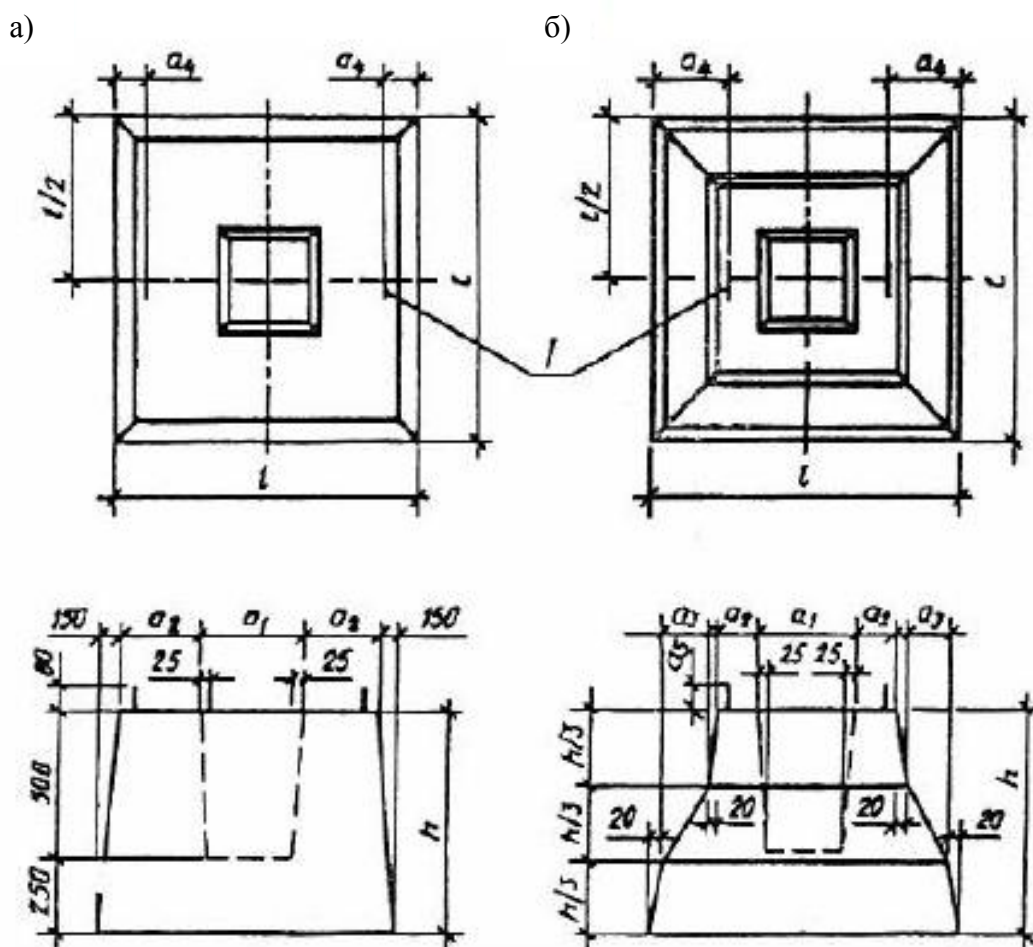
Общий вид фундаментов: 1 – монтажная петля
